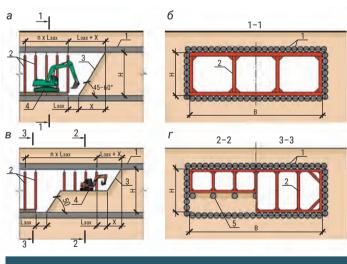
Схемы разработки грунта под защитой экрана из труб:
